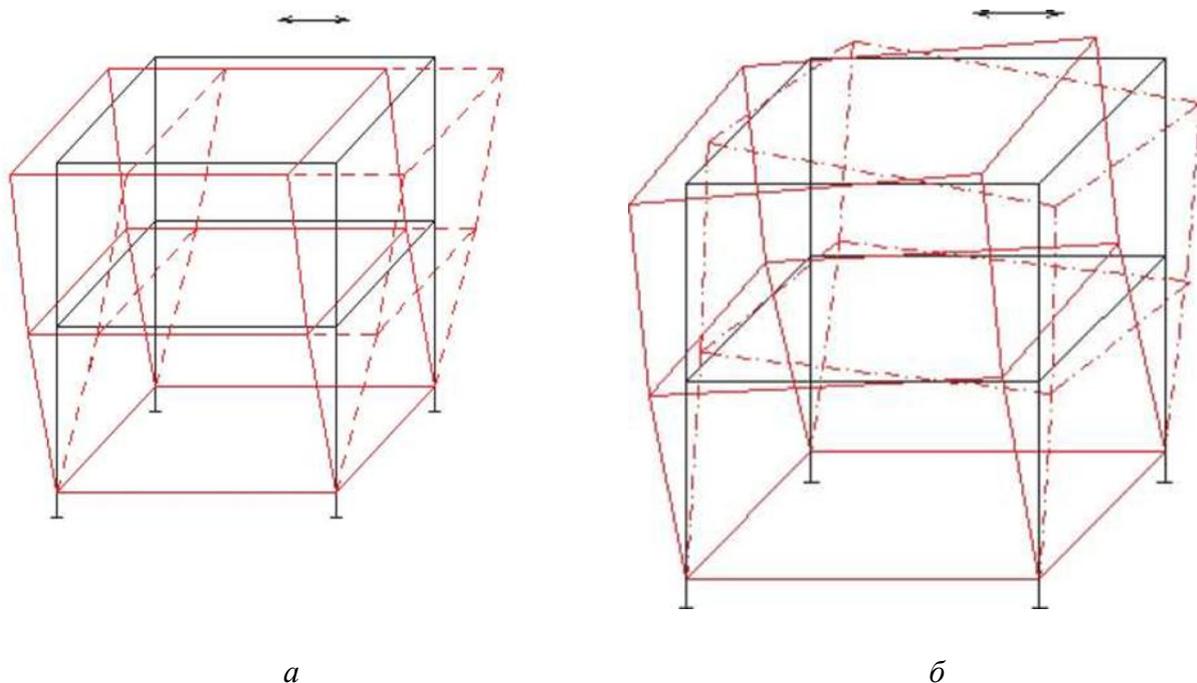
Схемы деформирования стенда на этапе испытаний II.
